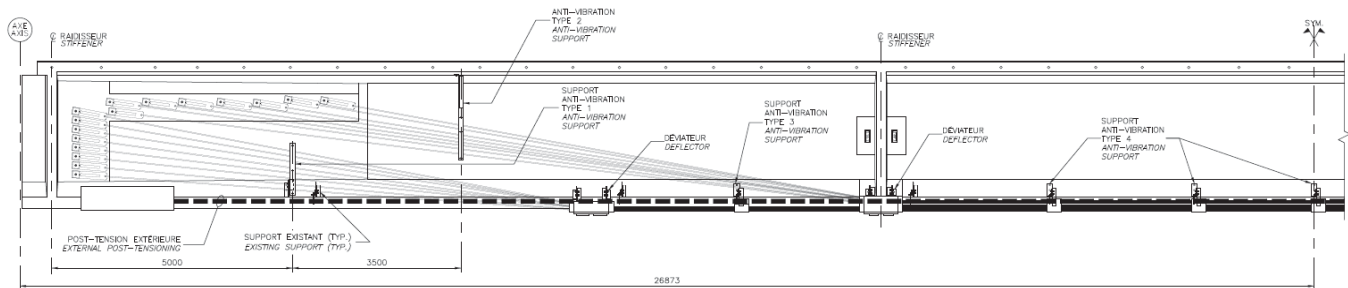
Poutres en béton – Renforcement par QP1 – Coupe transversale (source : ct 61315)
